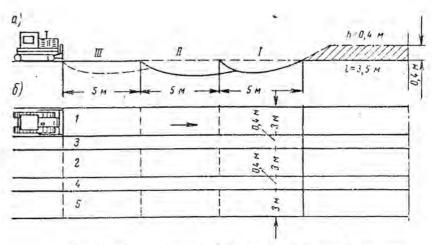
Возведение насыпи из боковых резервов по способу новатора а — последовательность зарезания (I, II, III); б — план разработки резерва по траншейнополосной схеме;
